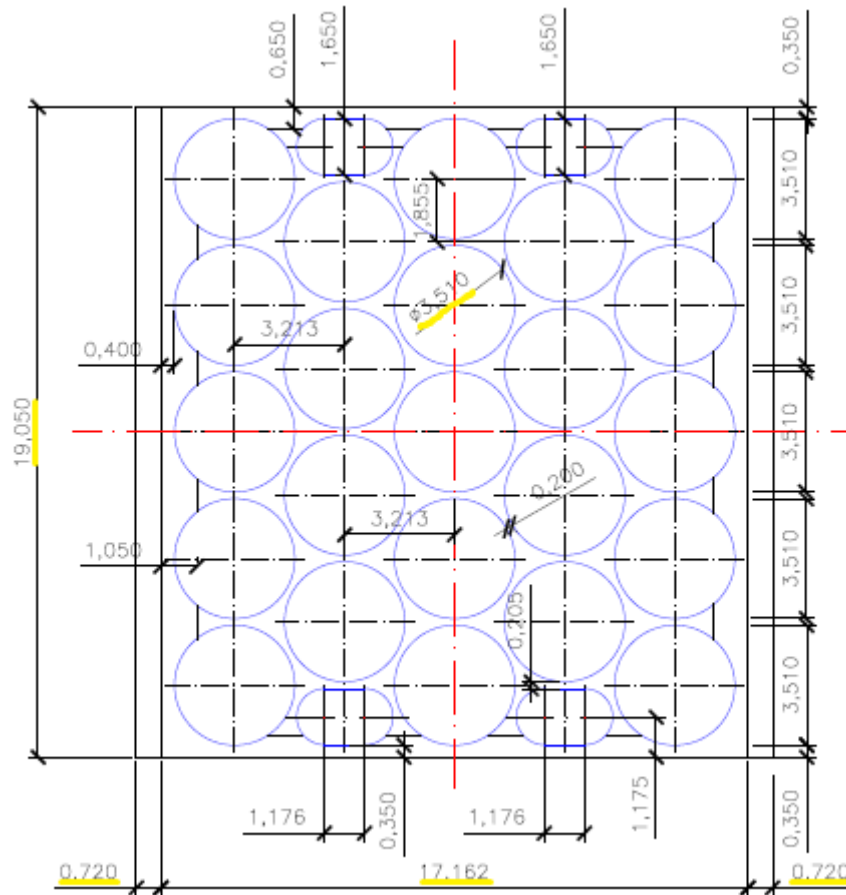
Plano en planta del cajón “ALFA” [4]
